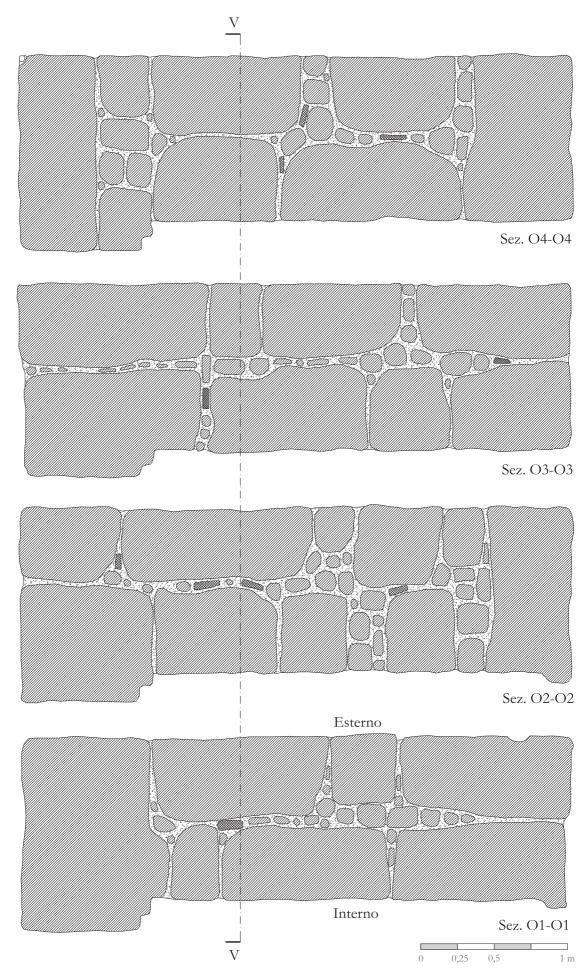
Dettaglio dell'apparecchiatura muraria in sezione orizzontale.
